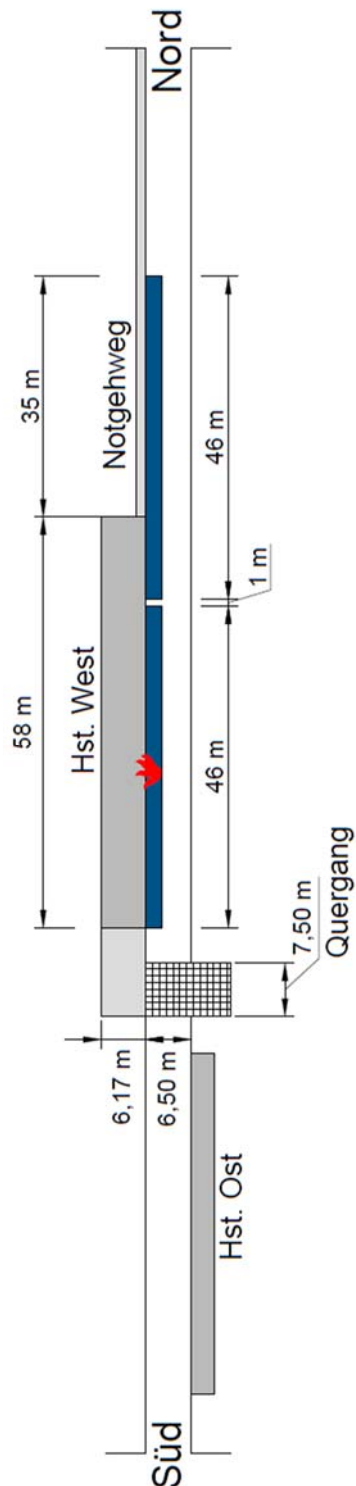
Fahrzeuganordnung für das beschriebene Szenario im Bereich der Haltestelle West-(Grundriss, Prinzip)
